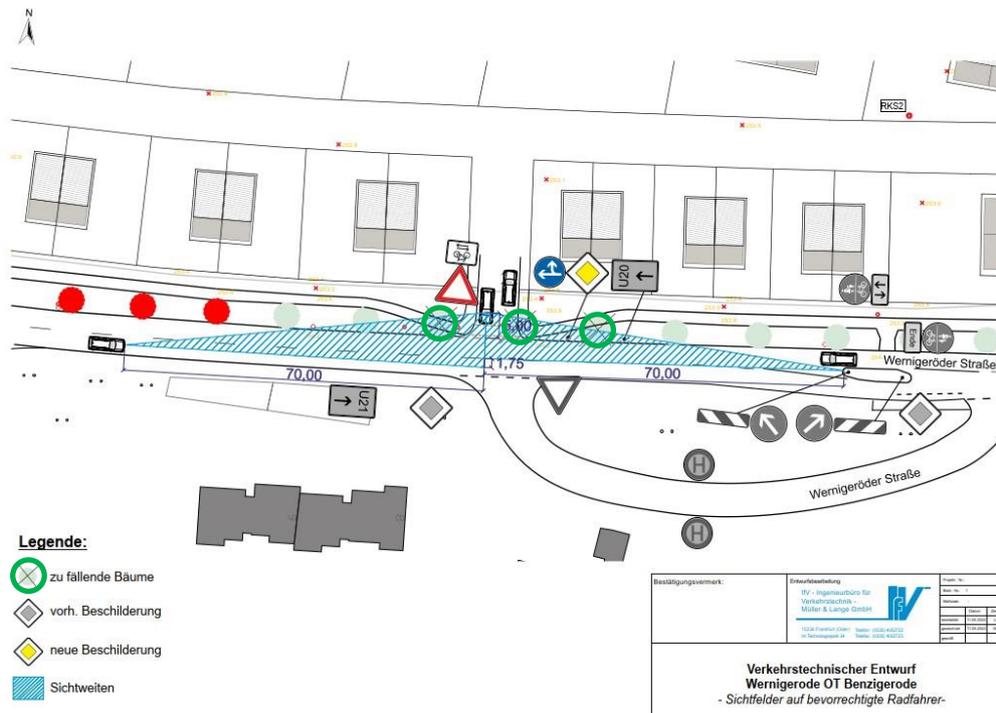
Geplanter Einmündungsbereich mit Sichtdreiecken
